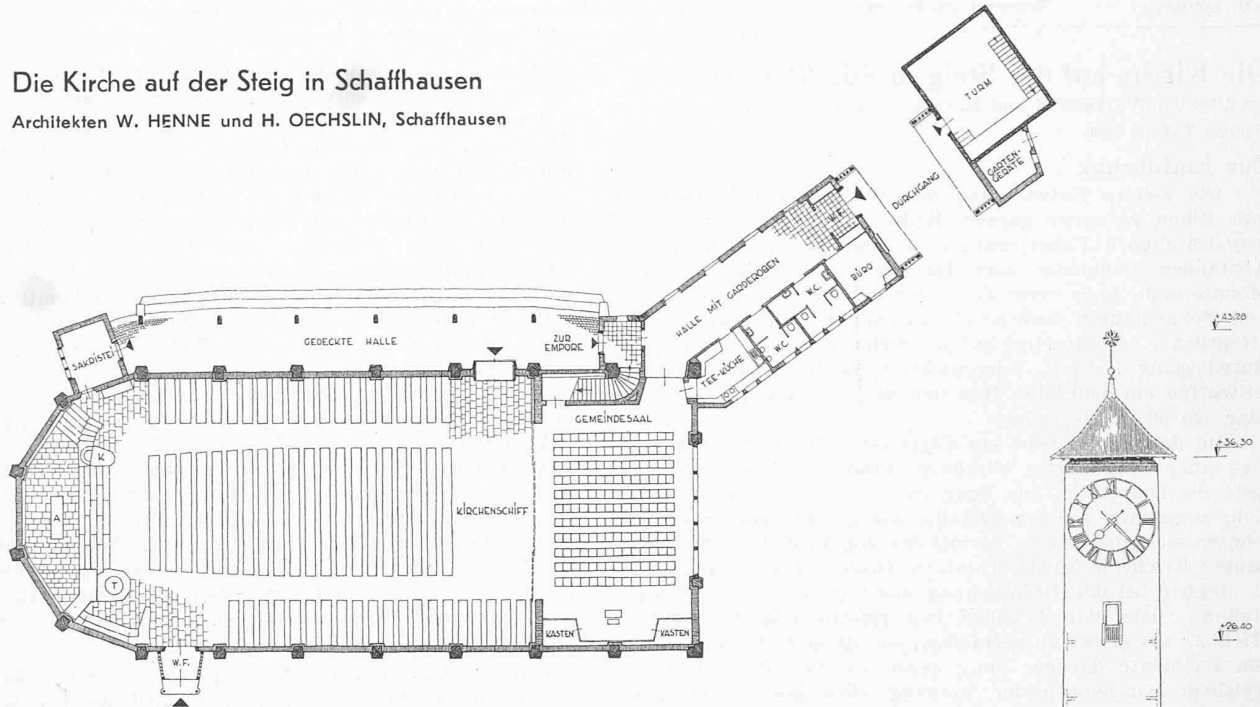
Grundriss des Erdgeschosses, 1:400. Ueber dem Gemeindefaal liegt die Sängerempore mit der Orgel
